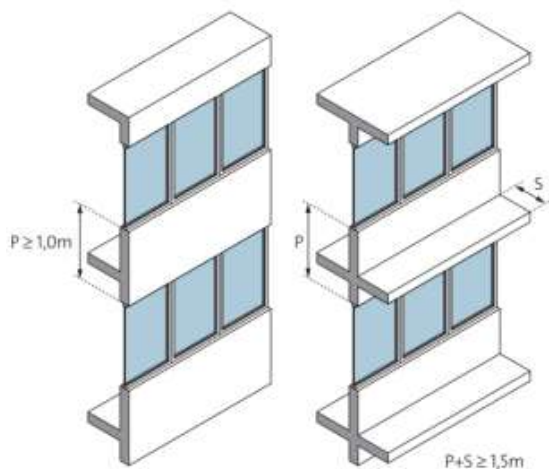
Parandalimi i përhapjes vertikale të zjarrit - dimensionet minimale të pengesave kundër zjarrit të vendosura nëpër elementët rezistues ndaj zjarrit [12].
